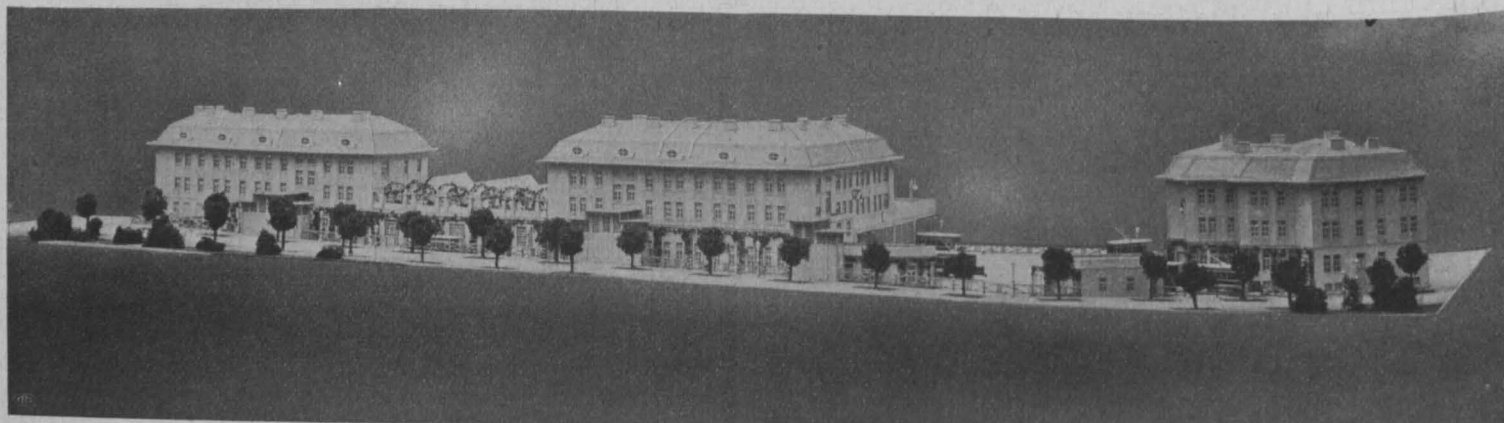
Ausstellung der Stadt Wien. Straßenbahnhof XII., Koppreitergasse.
